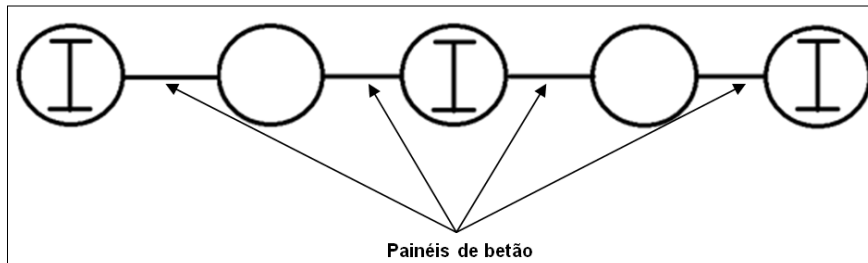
Alinhamento de colunas afastadas (neste caso com um painel de betão para ligação)
